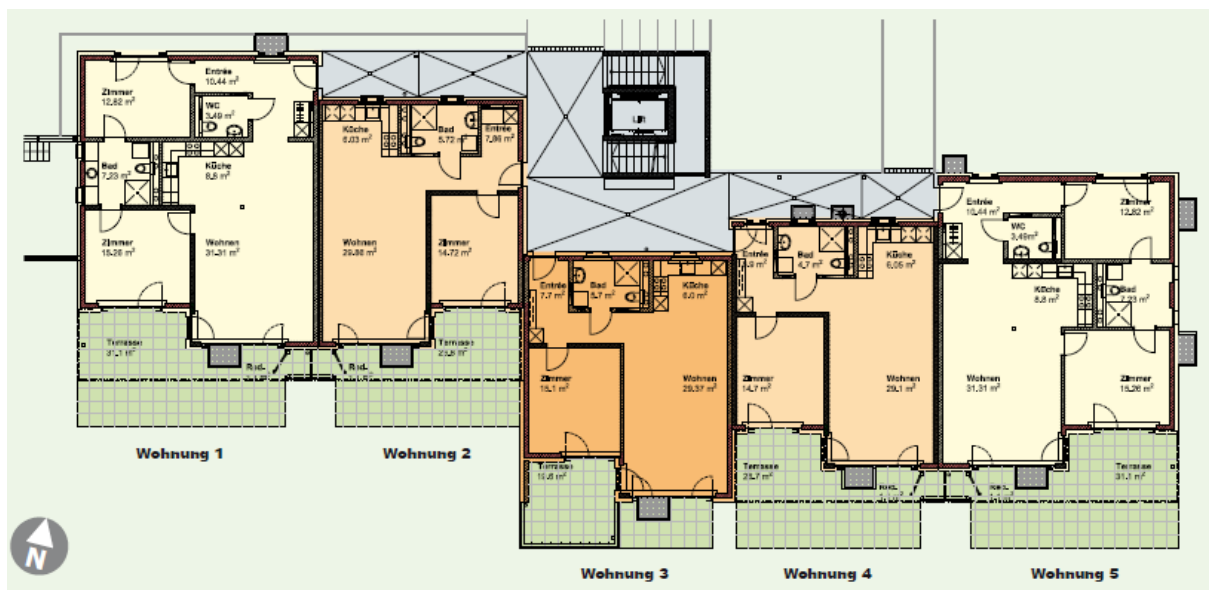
Grundriss Erdgeschoss mit Spitexwohnung Nr. 3
